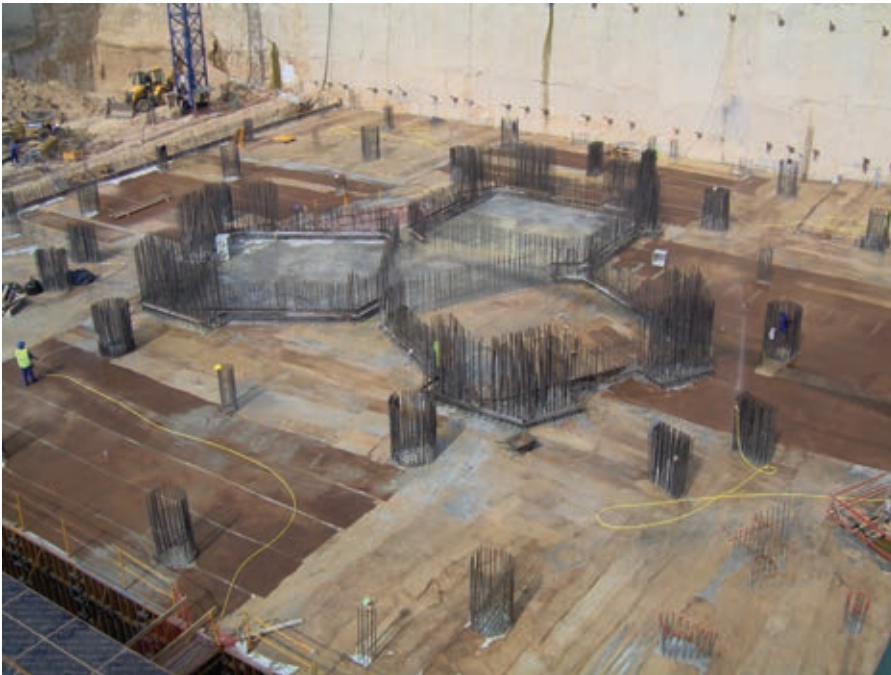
Vista general de la losa de cimentación tras el hormigonado de la segunda tongada, mostrando los arranques de los soportes y núcleos, así como las medidas de protección durante el curado.
